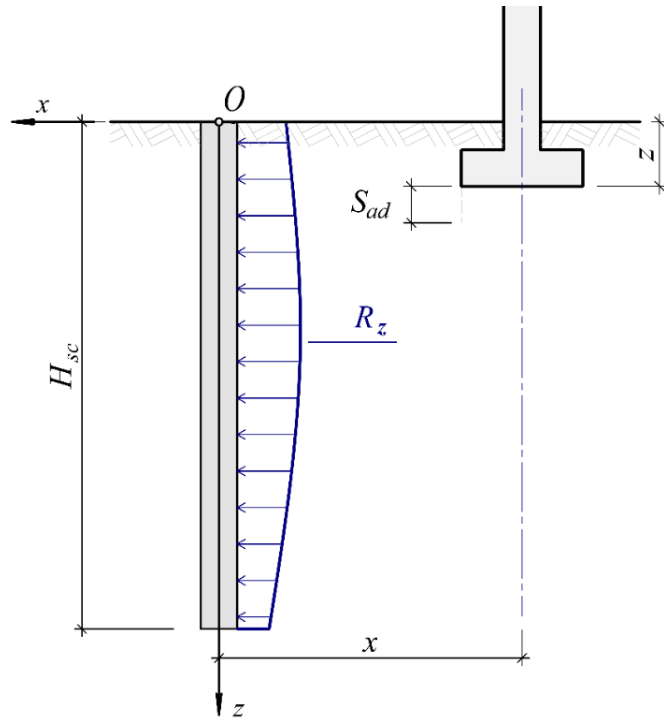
Расчетная схема к определению дополнительной осадки фундамента.
